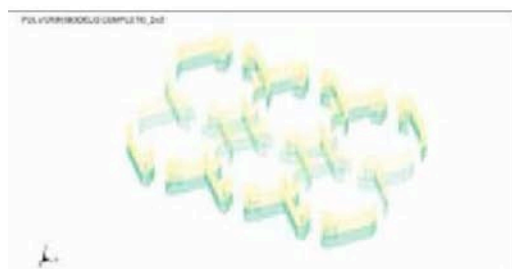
Armaduras inclinadas horizontales Ø25 y Ø32 mm
